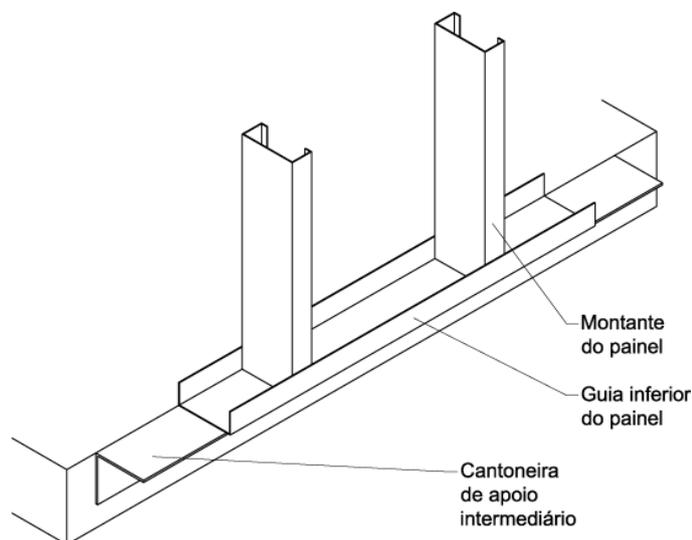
Detalhe para fixação inferior do painel contínuo
